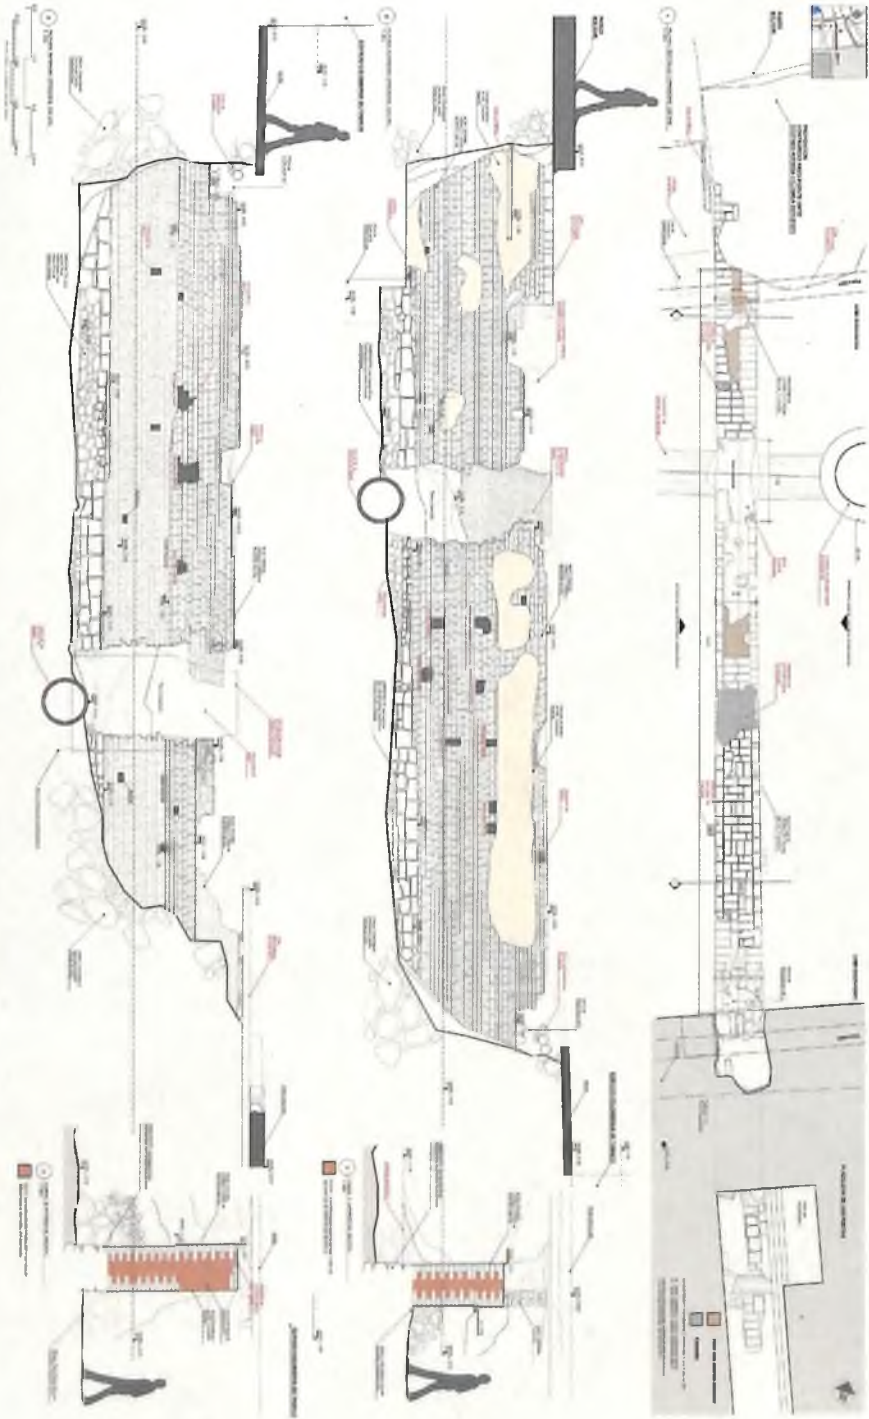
Detalle del muro este (aguas abajo) que conforma el estribo sur del puente de calicanto.
